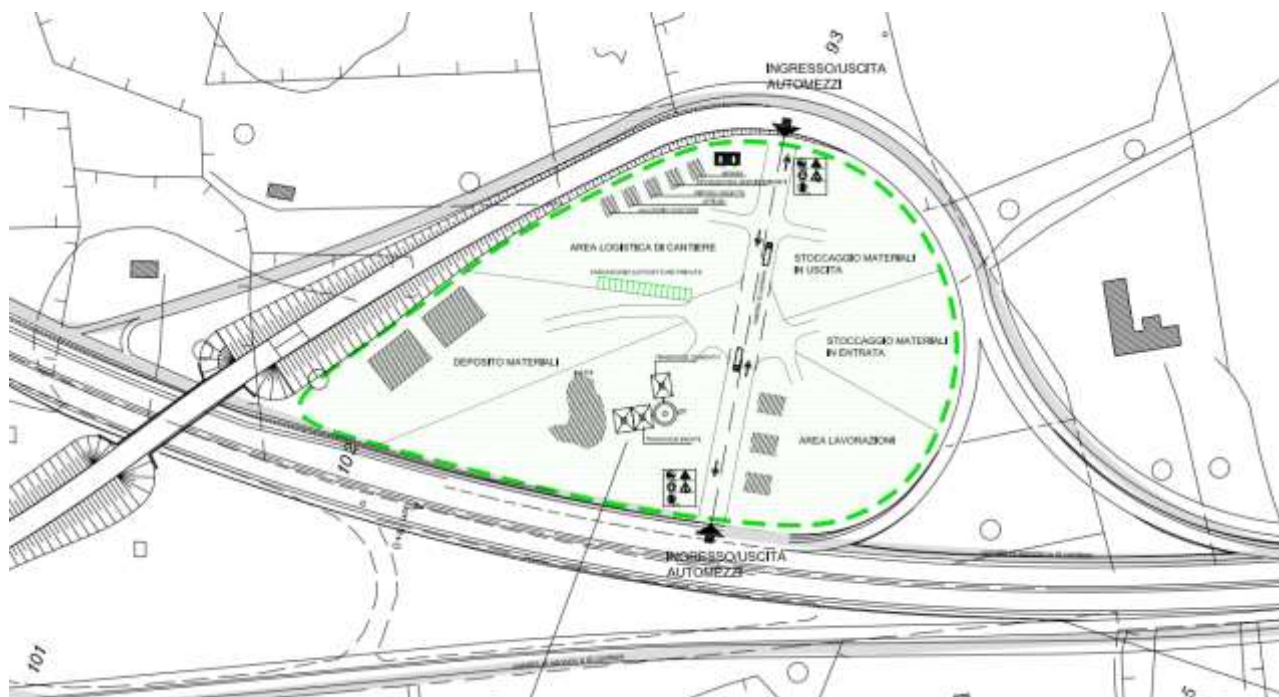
Area di cantiere 1 – PD 2005 - Dettaglio
